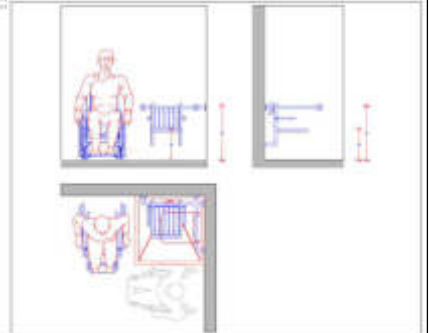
Nella sezione trasversale, la tazza w.c. è fissata al muro e il suo ingresso è fissato al suo interno in cui è contenuta la cassetta di risciacquo, permette anche con sanitari non "bidet" di ottenere una distanza del bordo anteriore dalla parete superiore di 65 cm per l'accostamento laterale della sedia e, contemporaneamente, di avere una "schiena" d'appoggio una volta trasferiti sul sanitario. Il doccino da doccia, dotato di 40 cm di movimento al sanitario verso l'alto con la quale diventa di circa 90 cm. Per questo tipo di lavandino, l'altitudine viene posta ad un'altezza di 70 cm dal piano di calpestio ed a una distanza costante dal muro del pavimento di 80 cm.
